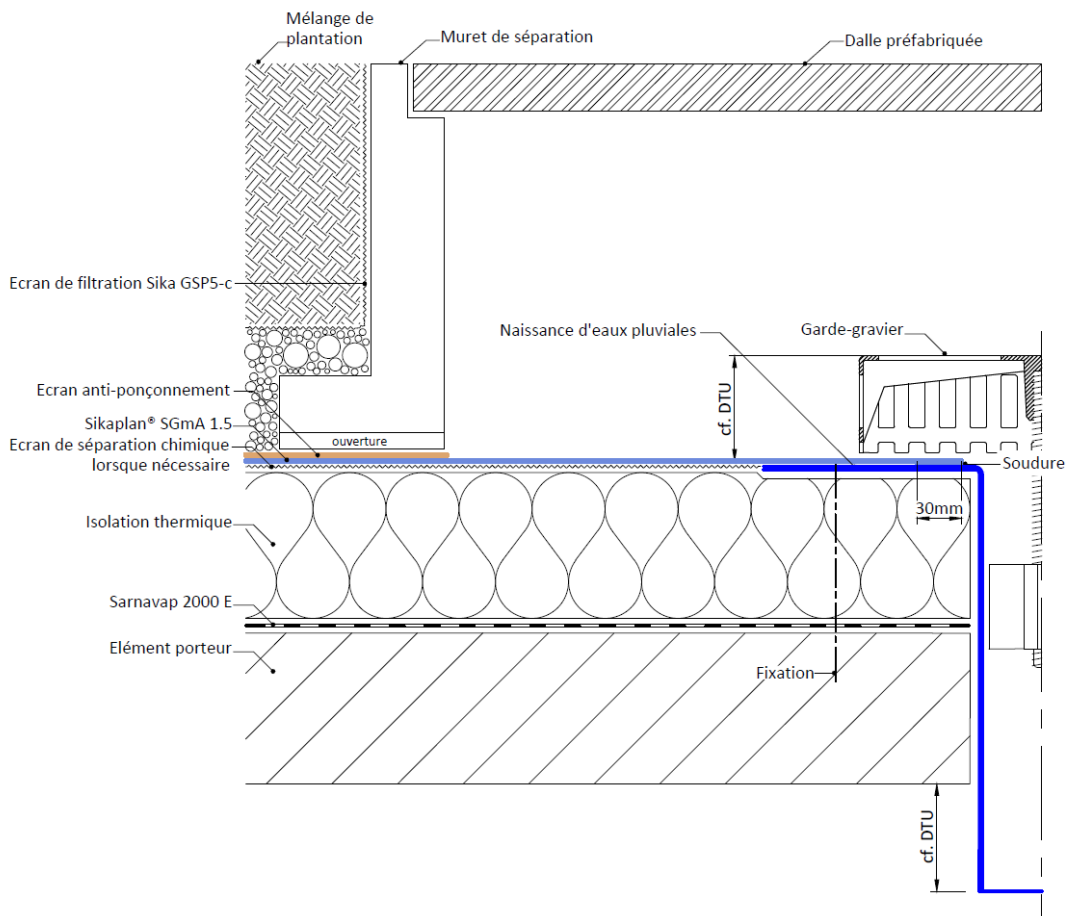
Relevé d'étanchéité sur acrotère avec zone stérile – Travaux neufs sur maçonnerie – Terrasse jardins
